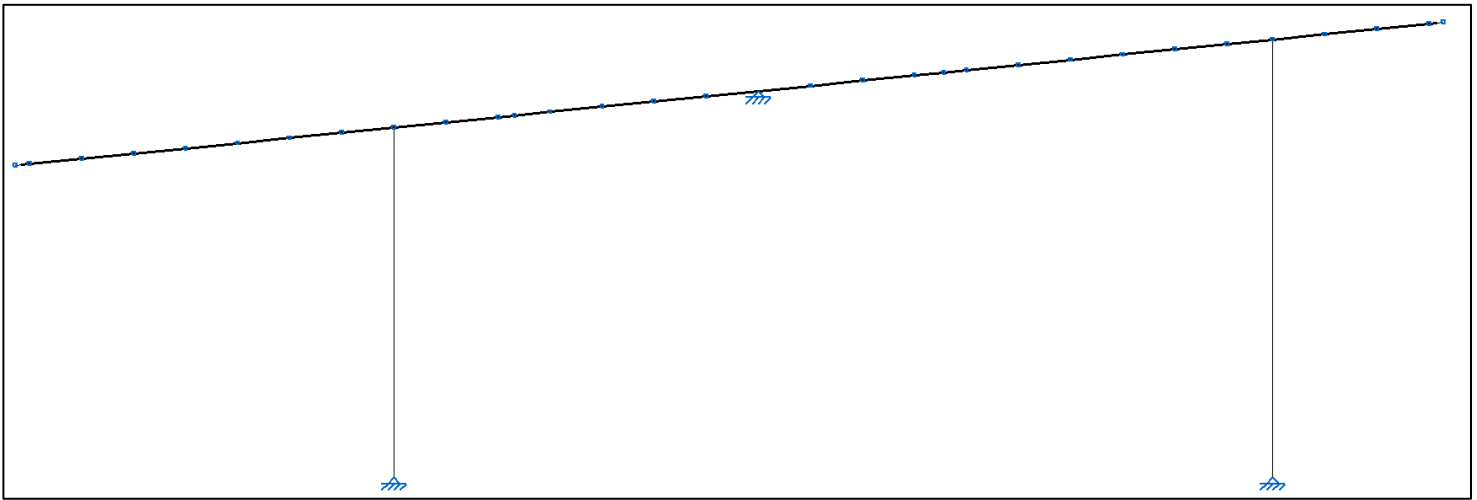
Esquema de cálculo del pórtico metálico adoptado
